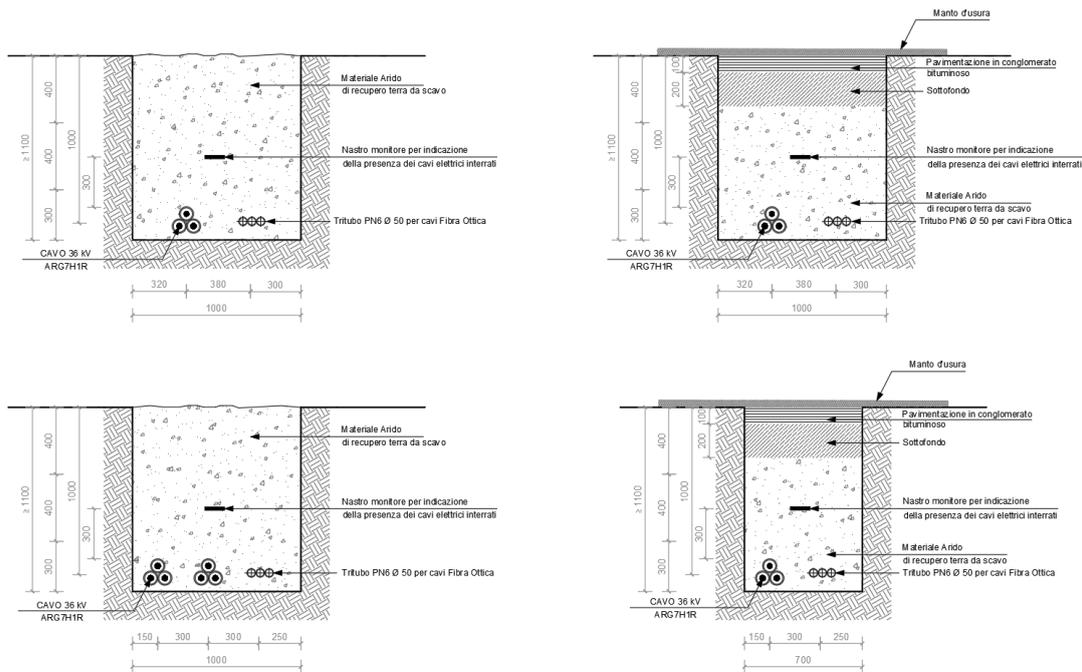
Tipico modalità di posa cavidotto a 36 kV di collegamento impianto FV – SE RTN
